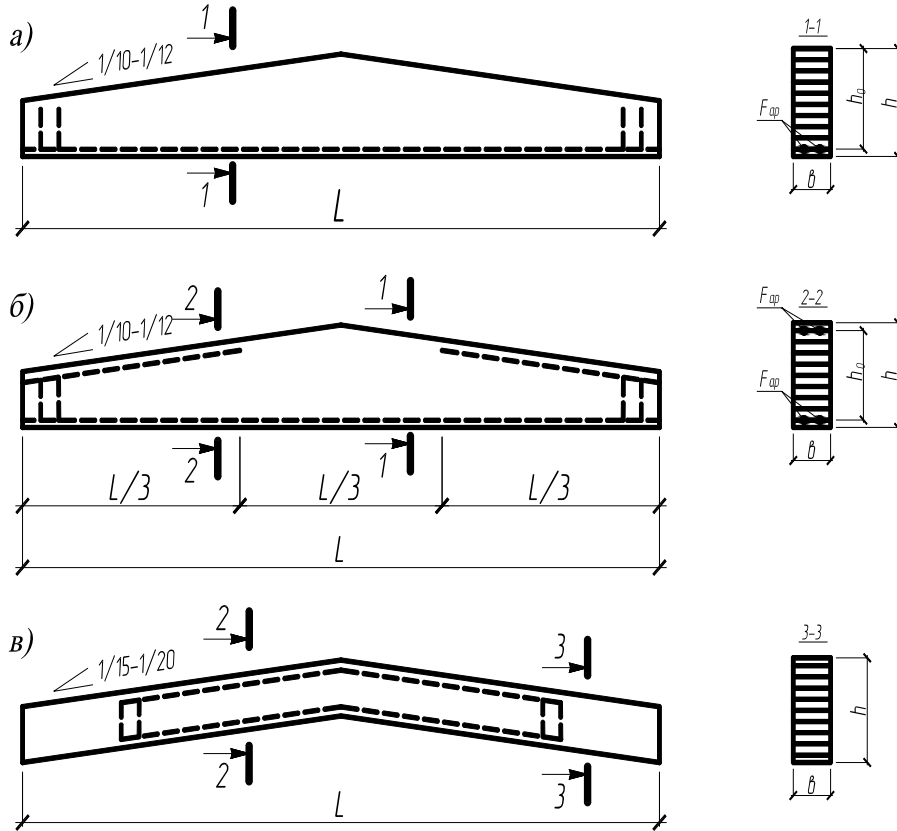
Клееные армированные двускатные балки: а – с одиночным армированием; б – с двойным симметричным армированием; в – с двойным симметричным армированием на части пролета
